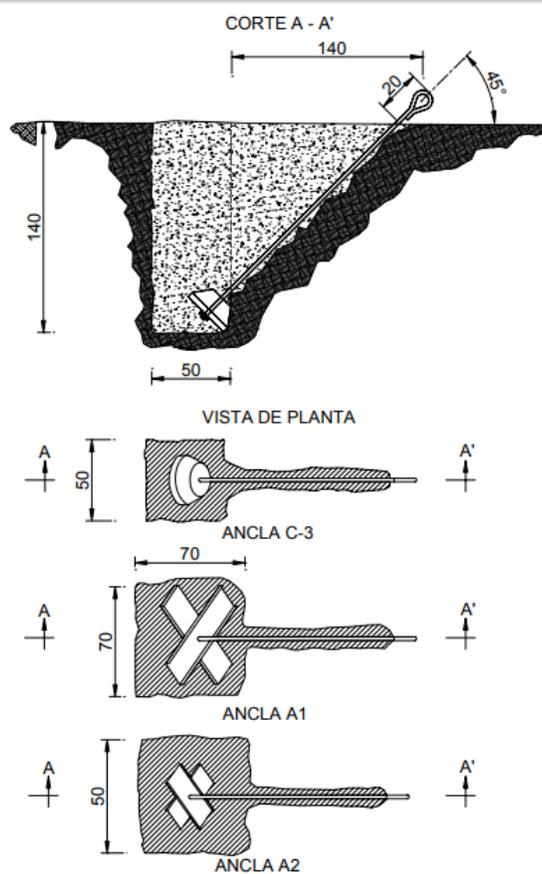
(a) Dimensiones de cepa para ancla
